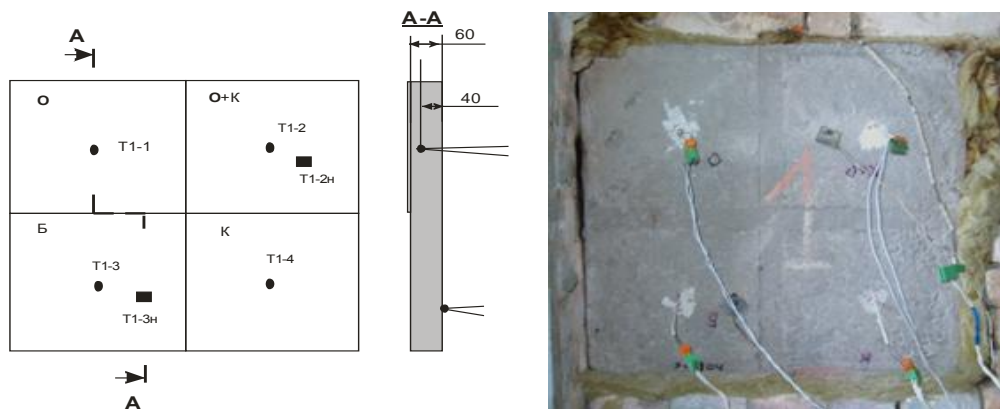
Схема расположения термопар на перегородке и вид перегородки перед огневыми испытаниями с необогреваемой стороны: О – огнезащитное покрытие; К – грунтовка; Б – бетон
